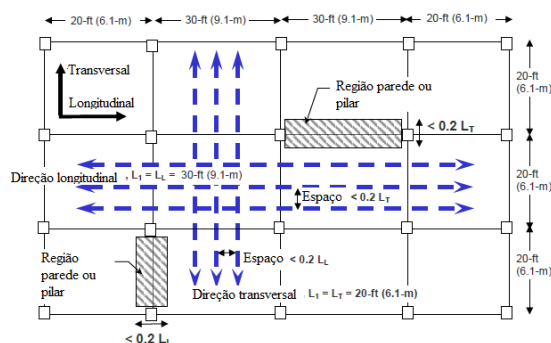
Espaçamento das amarrações (Adaptado de UFC 04-023-03 (2009)).
